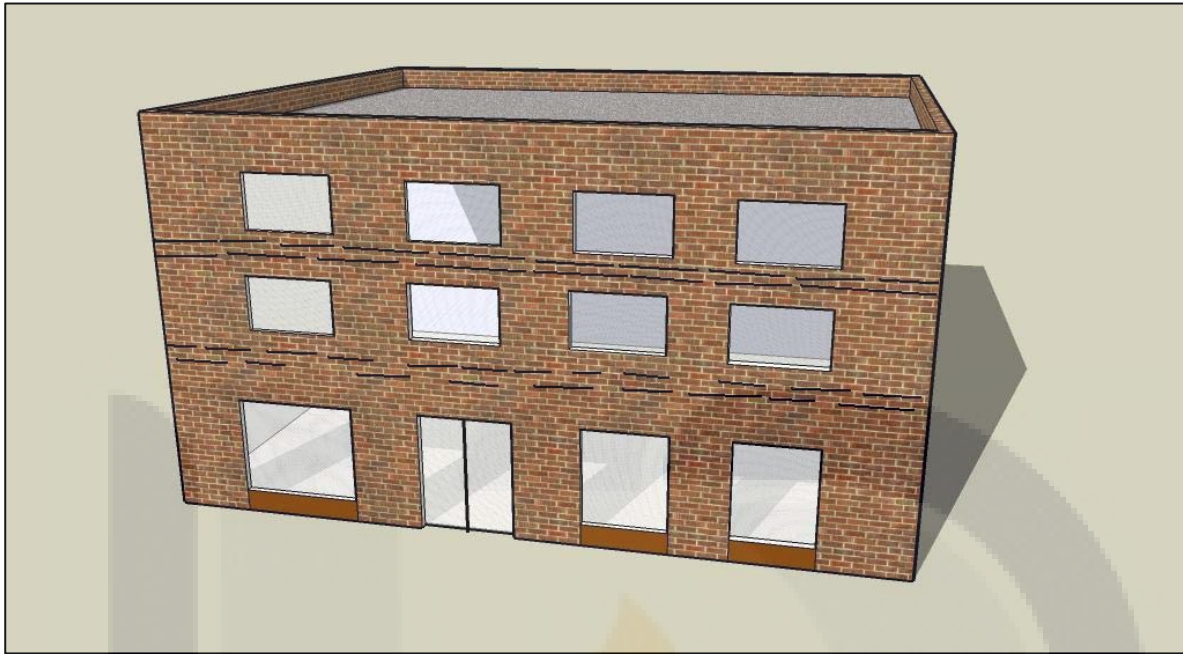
Grietas horizontales en los bordes de la losa de piso, debidas a un giro en el empotramiento del piso y la pared por una excesiva deformación de la losa de piso. Adaptado de Genescà et al., 1997.
